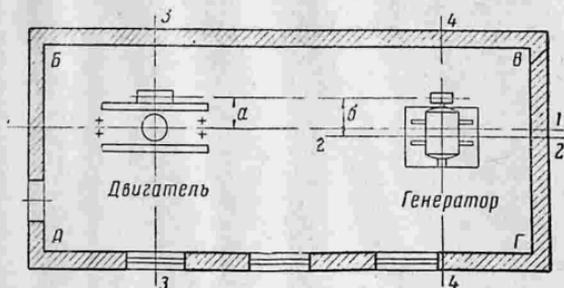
Разбивочный чертеж фундамента под двигатель и генератор.
